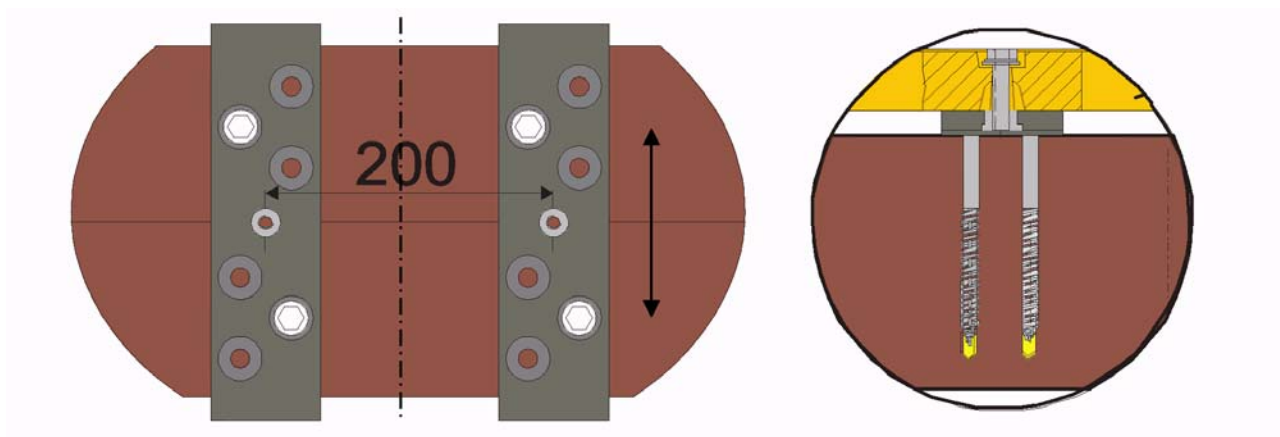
Montáž balízy s upevňovacou súpravou HB
